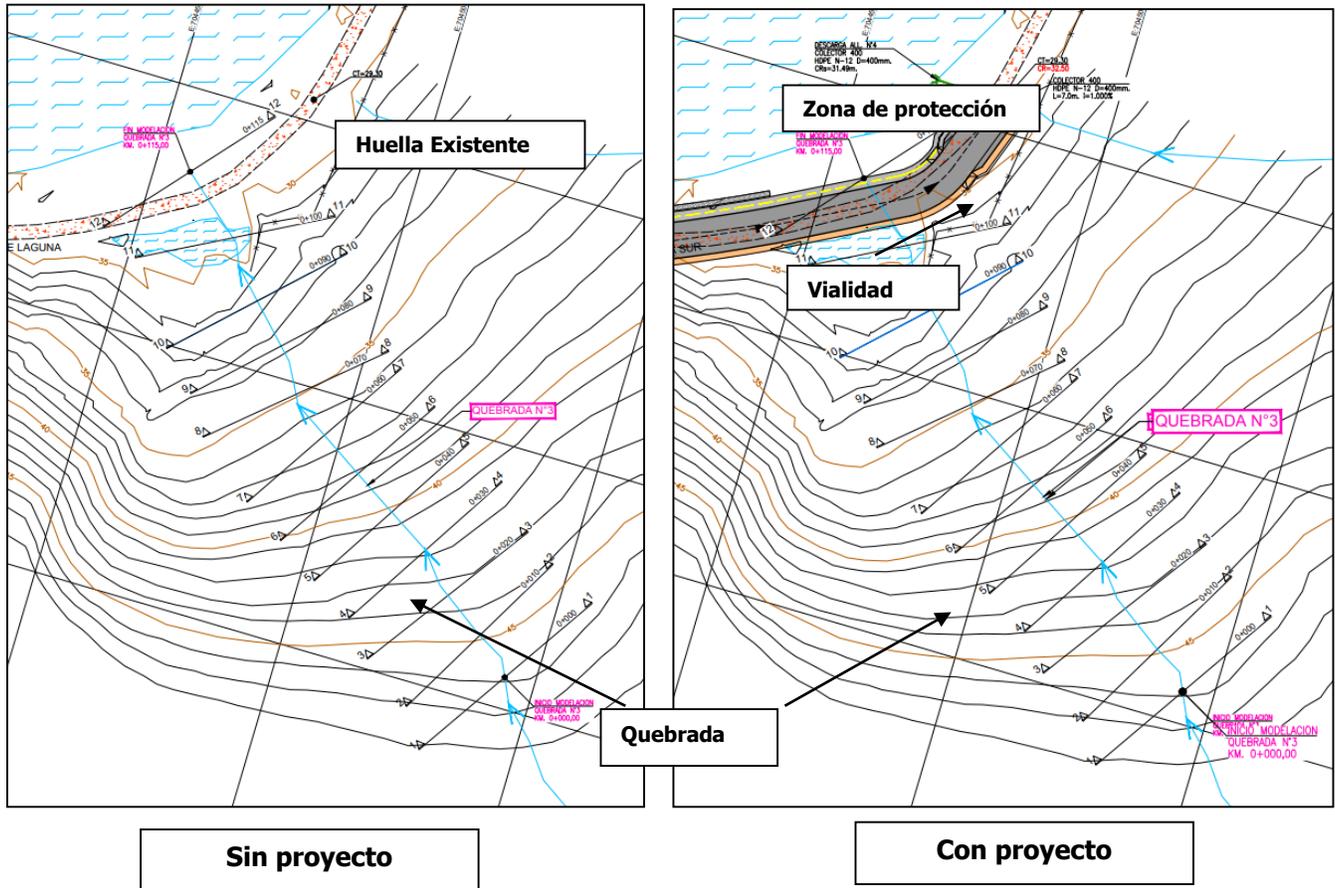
Detalle Quebrada 3 con y sin proyecto ZPdr
